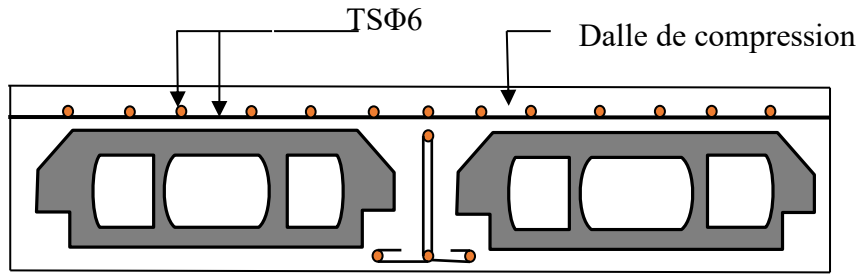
Schéma de ferrailage de la dalle de compression.
